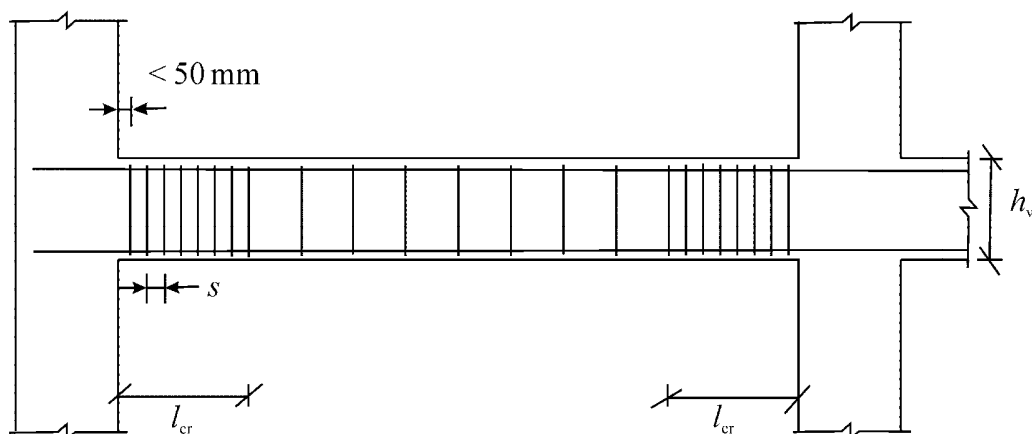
Armadura transversal en zonas críticas de vigas
